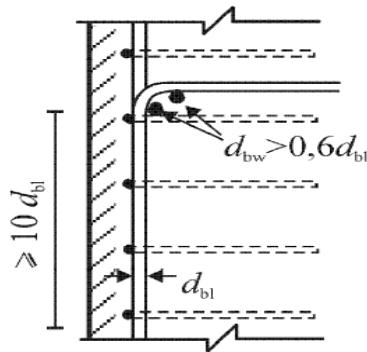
Dobragem dos varões longitudinais e colocação das armaduras transversais no interior
